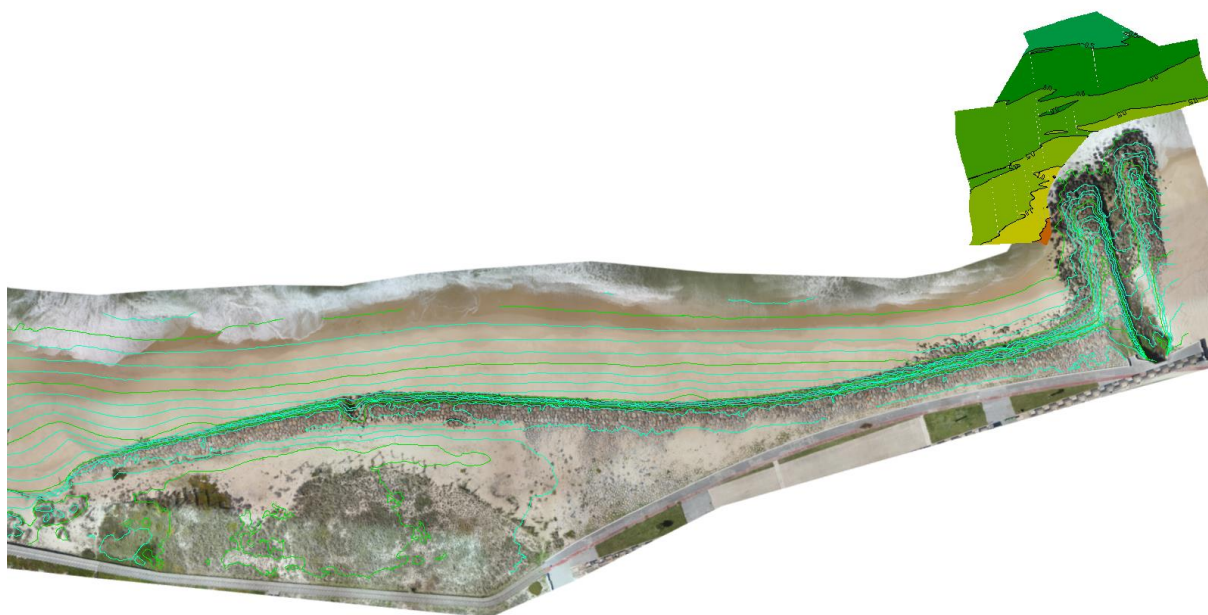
Planta da proteção da foz da ribeira de Silvalde e da proteção aderente associada.
